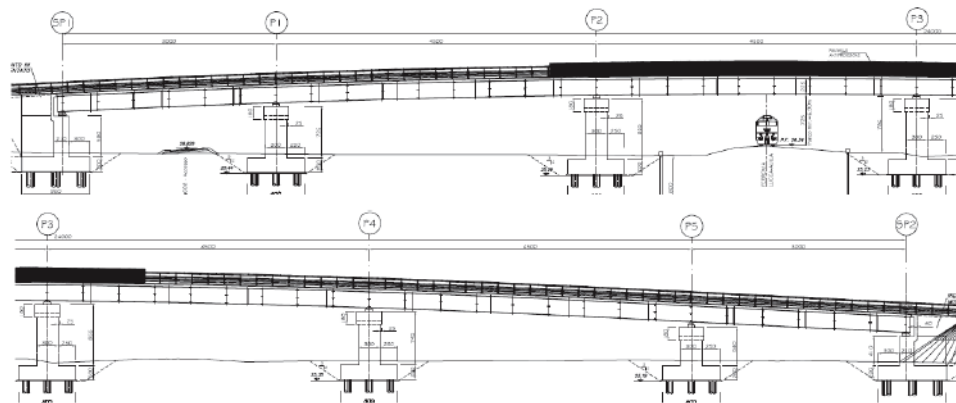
Cavalcaferrovia Lucca-Aulla: profilo longitudinale
